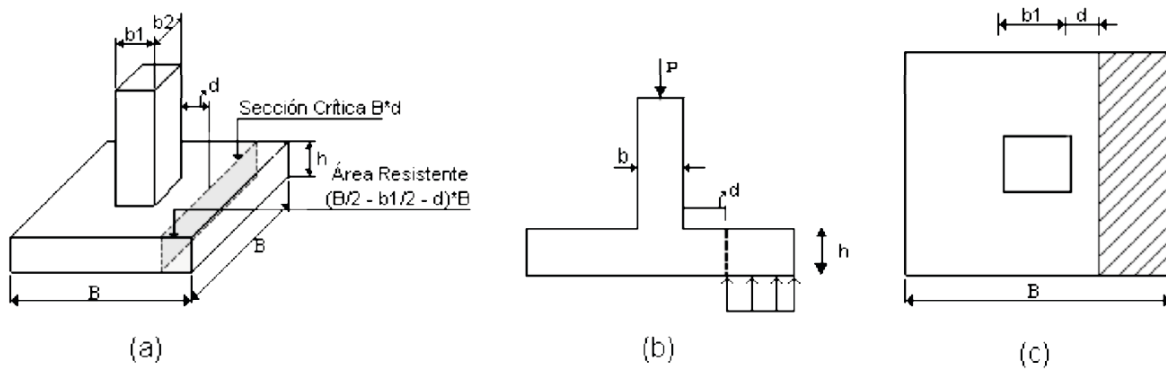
C CORTANTE UNIDIRECCIONAL EN ZAPATA QUE SOPORTA COLUMNA, PEDESTAL O MURO DE CONCRETO
